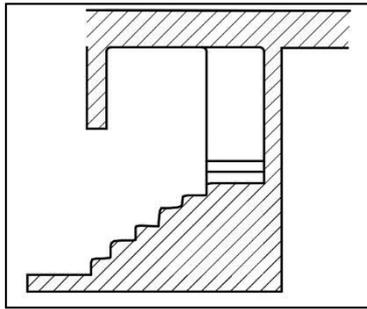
esclaiers sur blockage de pierres. source: fait par l'auteur
